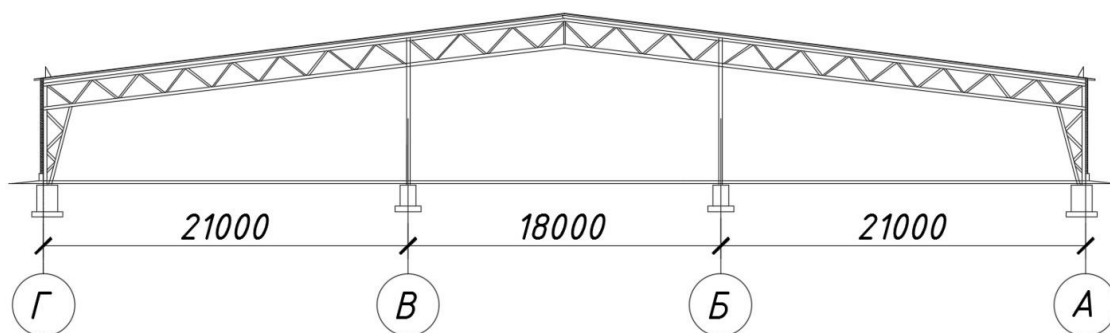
Конструкция каркаса из многопролётной решетчатой рамы
